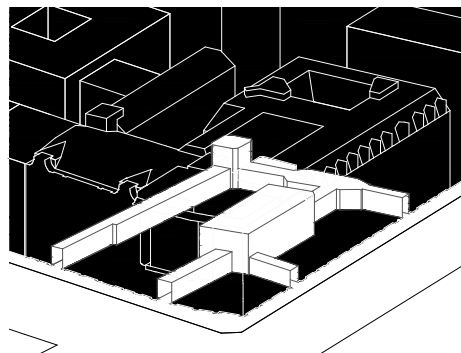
Pasáž paláce Avion 1:2000.
